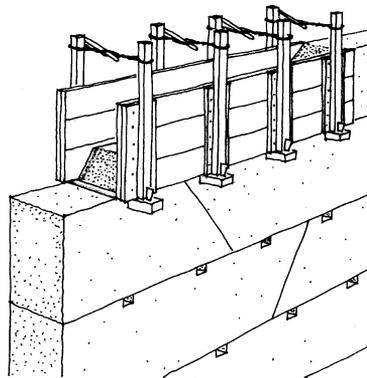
Traditionelles Werkzeug für Stampf- und Steinbau
